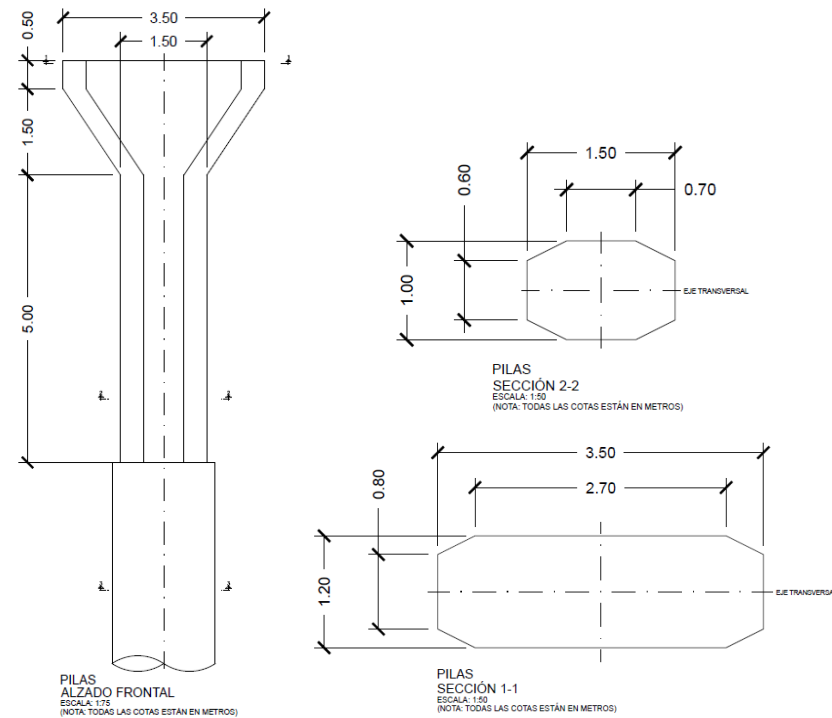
Vista en alzado y secciones transversales de las pilas del nuevo puente.
